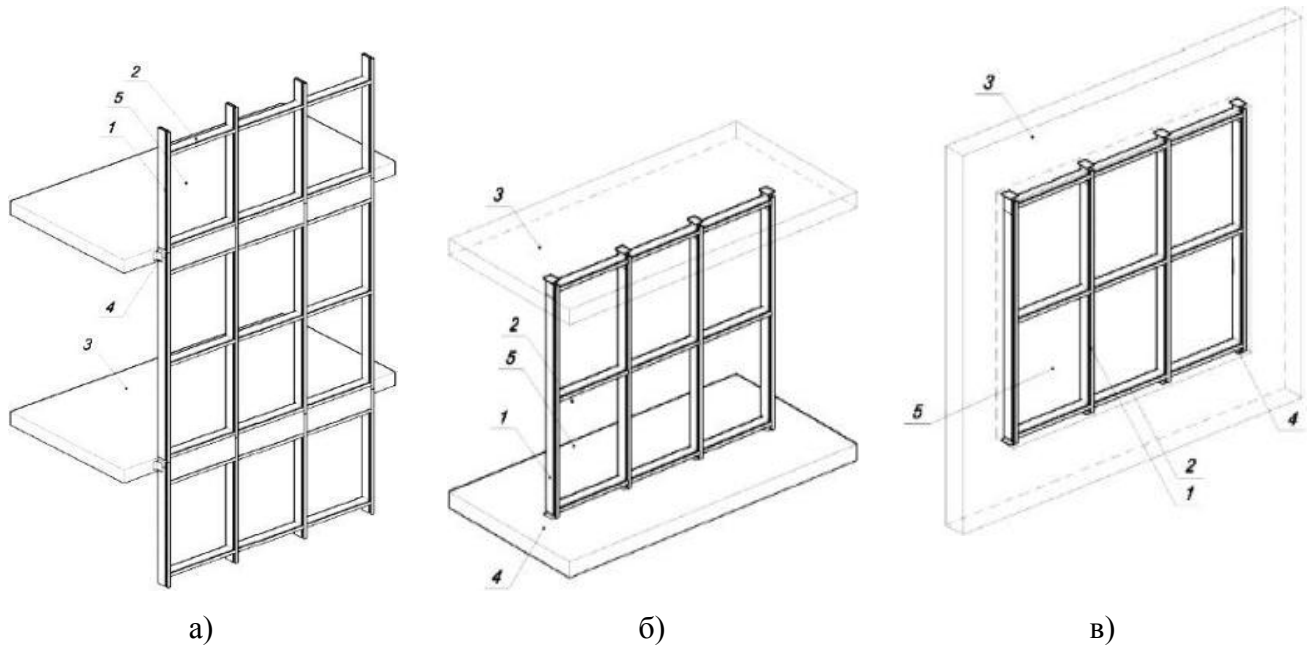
Типы светопрозрачных фасадных конструкций:
